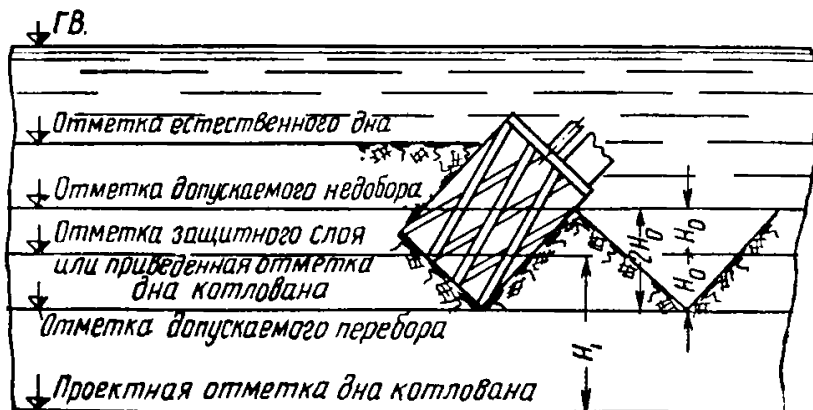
Схема разработки котлована земснарядом с фрезерным разрыхлителем
